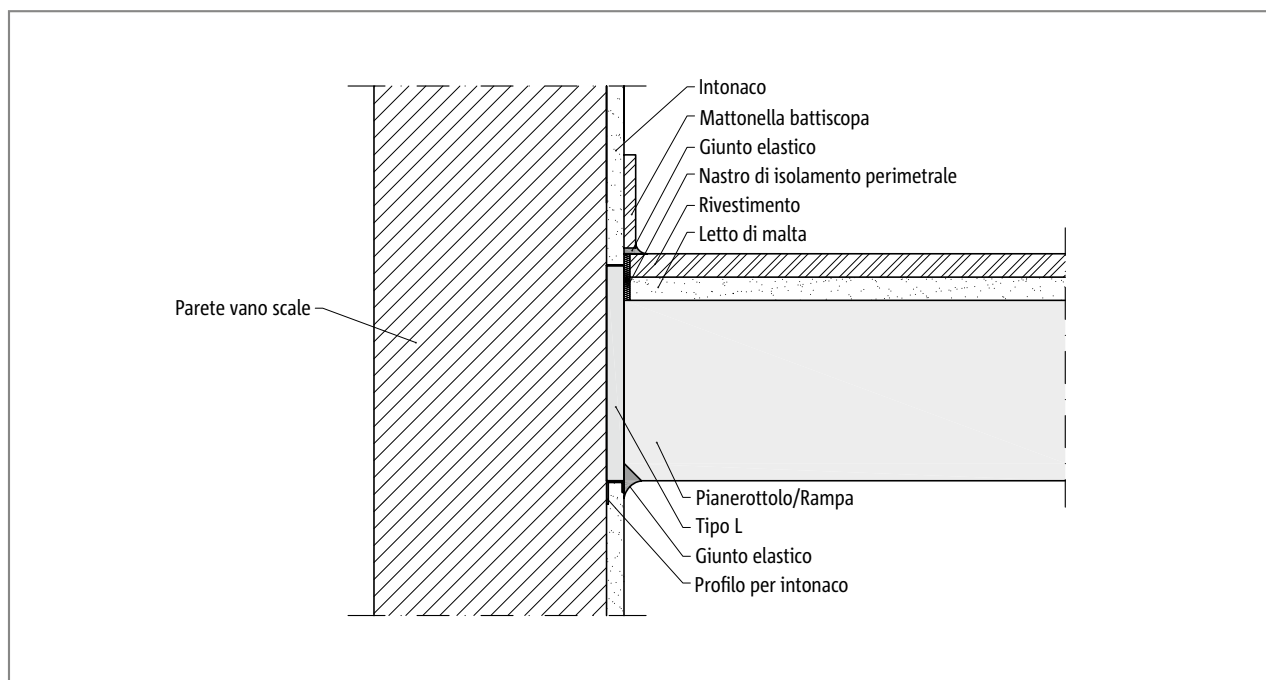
Schöck Tronsole® tipo L, sezione costruttiva - costruzione prefabbricata
